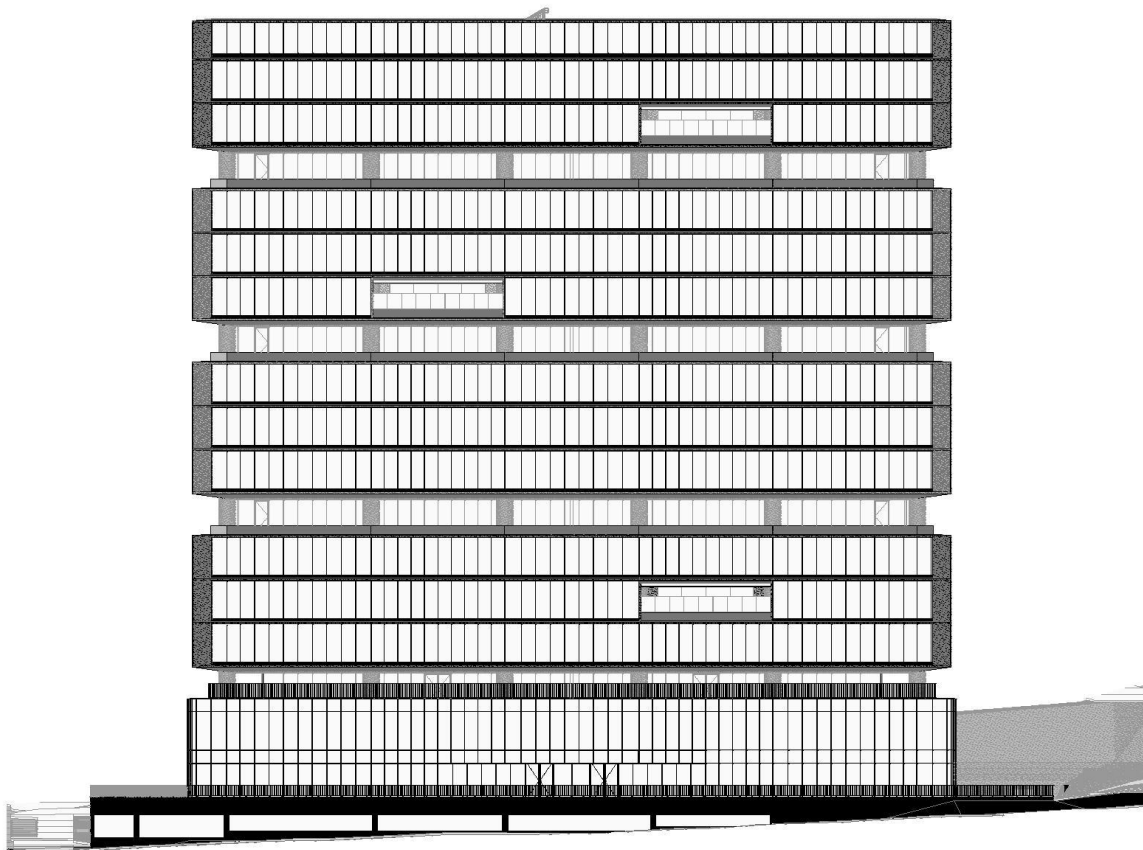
Fachada C / Esquerda (Norte) do Edifício Lótus Tower.
